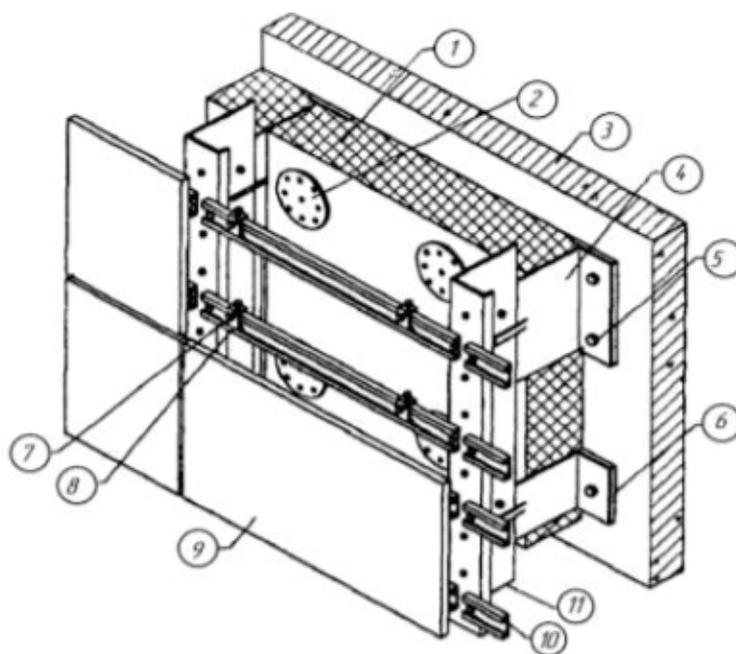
Конструкция вентилируемого фасада: 1 — утеплитель, 2 — тарелочный дюбель крепления утеплителя, 3 — основание, 4 — кронштейн, 5 — анкерный болт крепления кронштейна, 6 — паронитовая прокладка, 7 — распорный винт, 8 — кронштейн для скрытого крепления облицовочных плит, 9 — облицовочная плита из керамогранита, 10 — горизонтальный профиль, 11 — вертикальный профиль.
